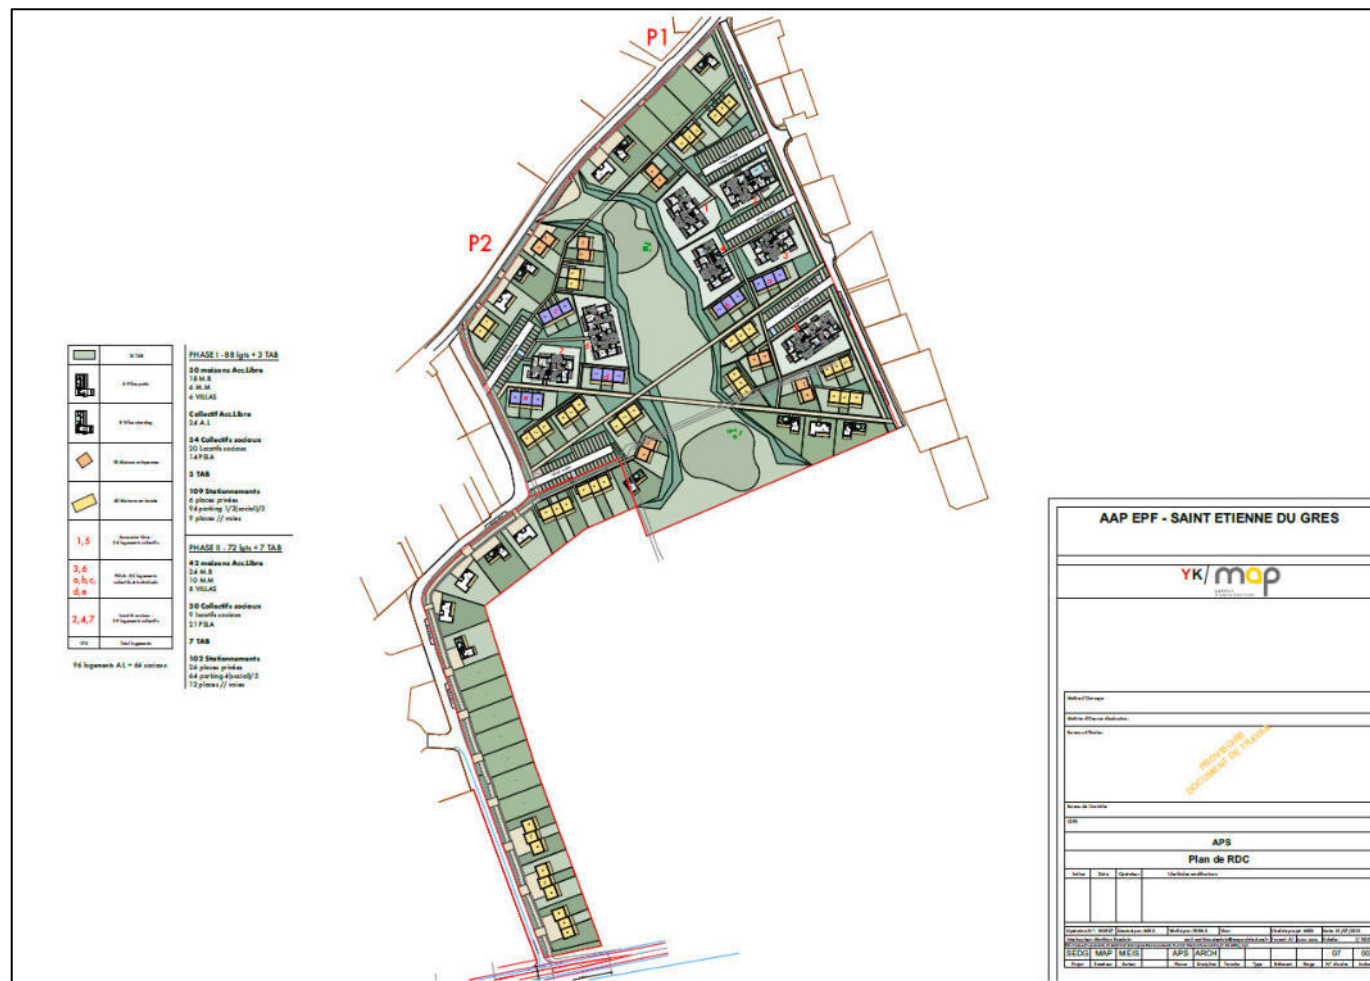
Plan de masse du projet d'aménagement (Map - architecture)
